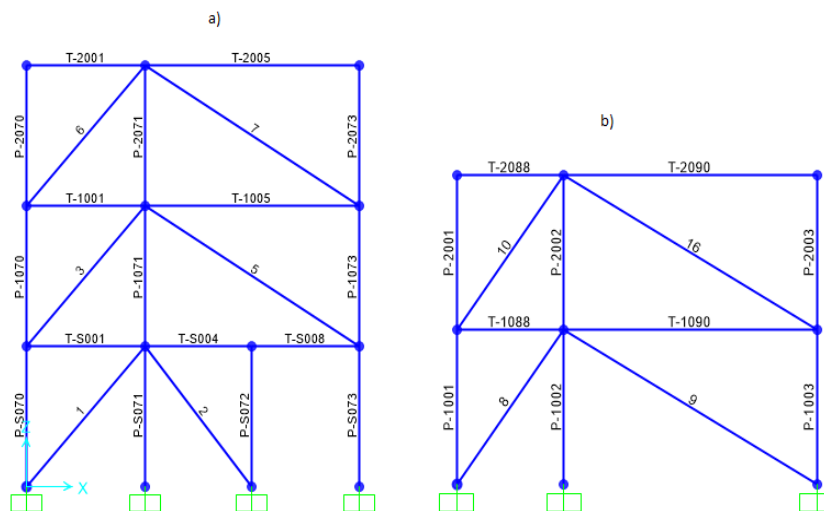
Disposizione dei controventi nel Telaio 1 (a), Telaio 2 (b).
